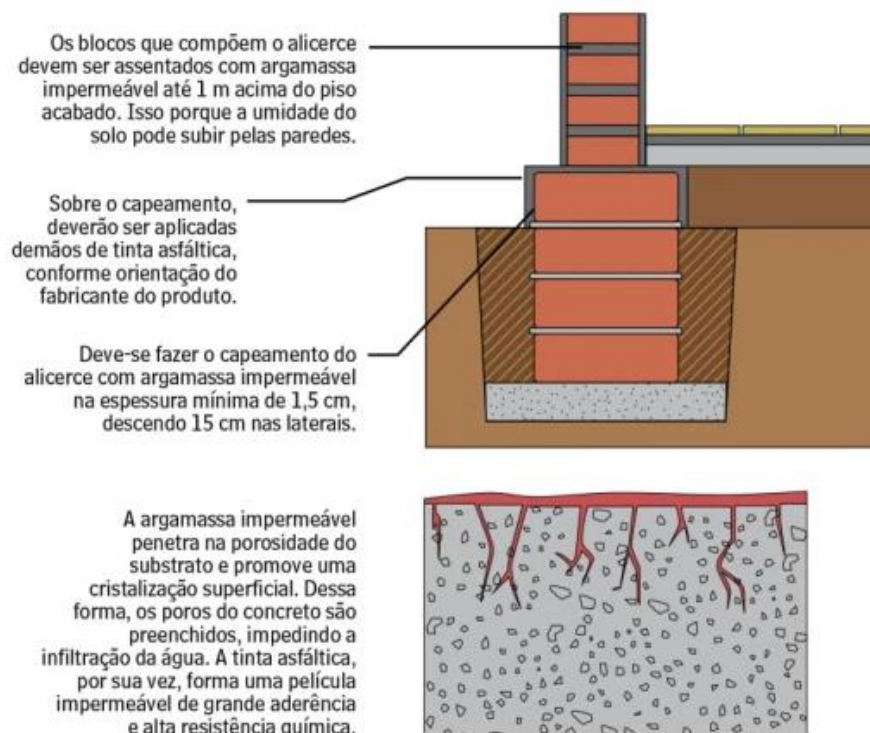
Aplicação de impermeabilizantes – Fundação Radier
